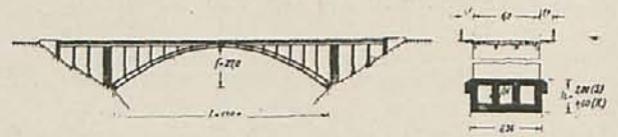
Puente sobre el Caille, en Cruseilles.
